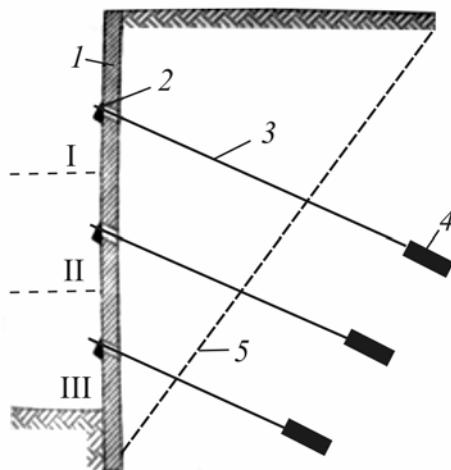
Схема анкерного крепления ограждающей стенки тремя ярусами наклонных грунтовых анкеров: 1 — стенка; 2 — стопорное устройство (оголовок); 3 — анкерная тяга; 4 — рабочая часть анкера; 5 — линия скольжения призмы обрушения грунта; I, II, III — этапы разработки котлована
